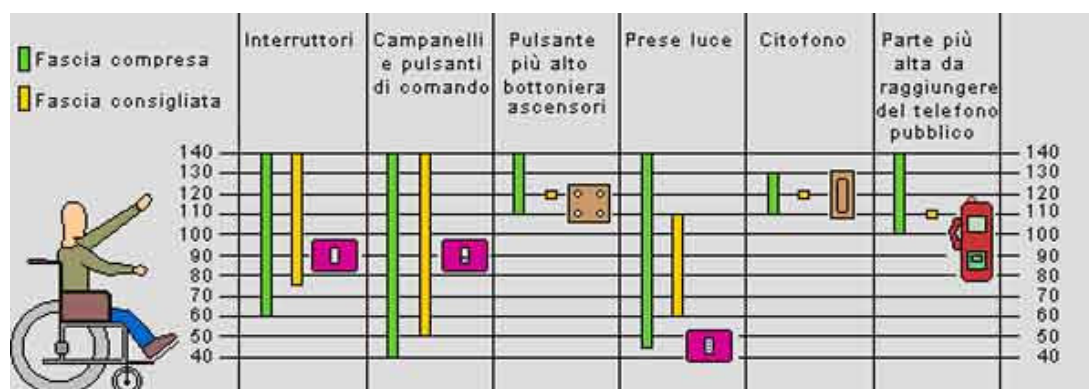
Ubicazione delle apparecchiature elettriche per l'abbattimento delle barriere architettoniche
